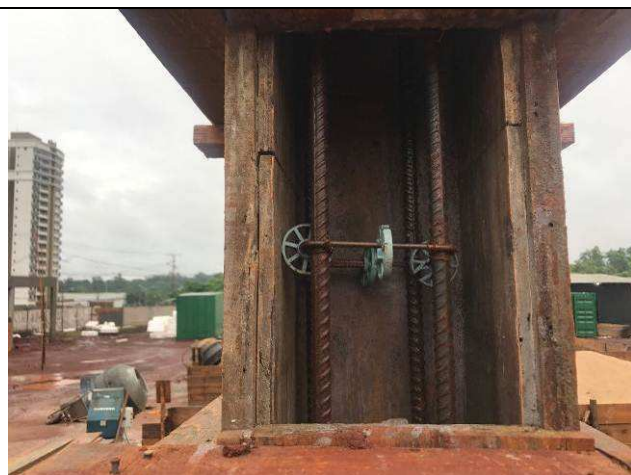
C: Formas e armaduras do pilar P57 do prédio principal.
